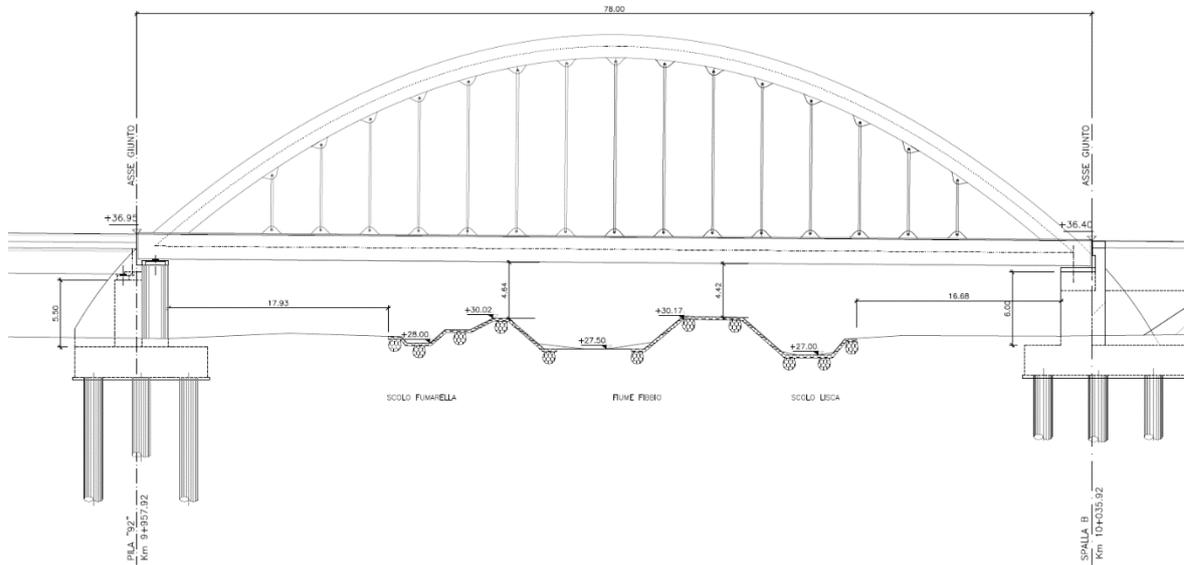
Sezione tipologica post operam (spalle e ponte estratti dal PD)
